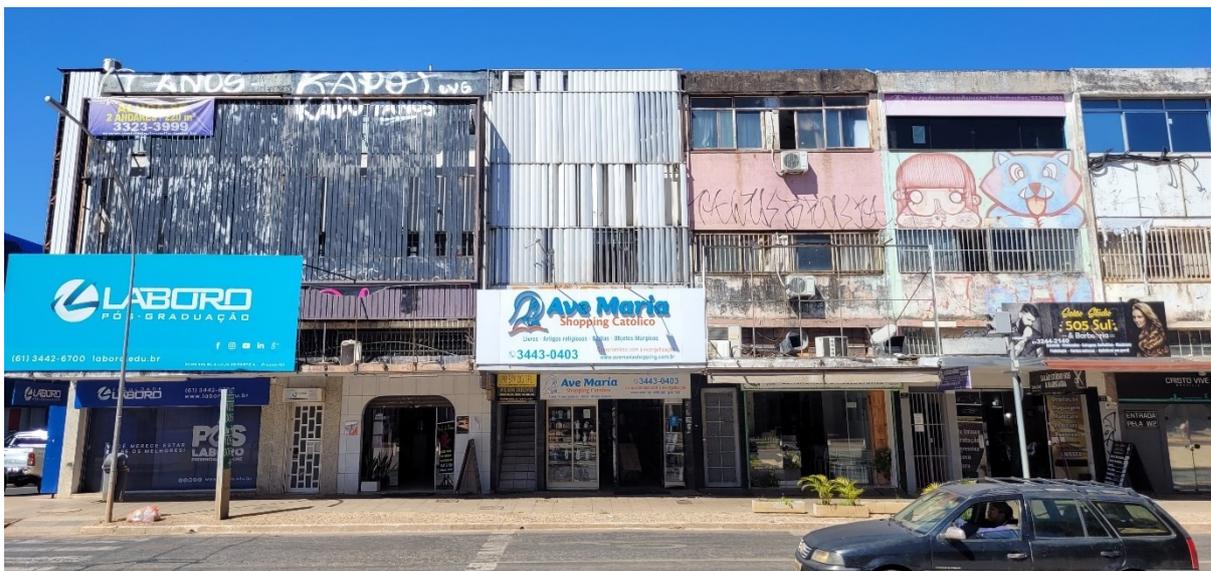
Colagem degradação espacial / Fonte: Acervo pessoal
